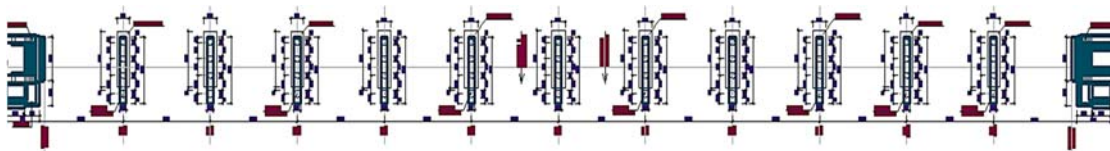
Planimetria. Prerje horizontale në risegën e plintave
